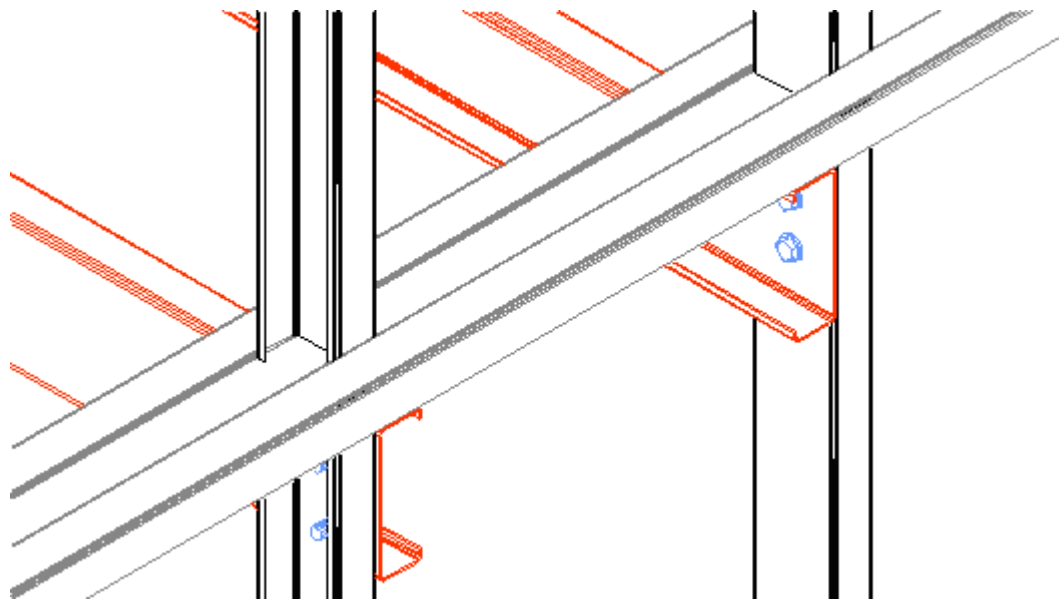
Esquema de montagem do sistema Apoio viga-montante - detalhe dos parafusos de fixação
